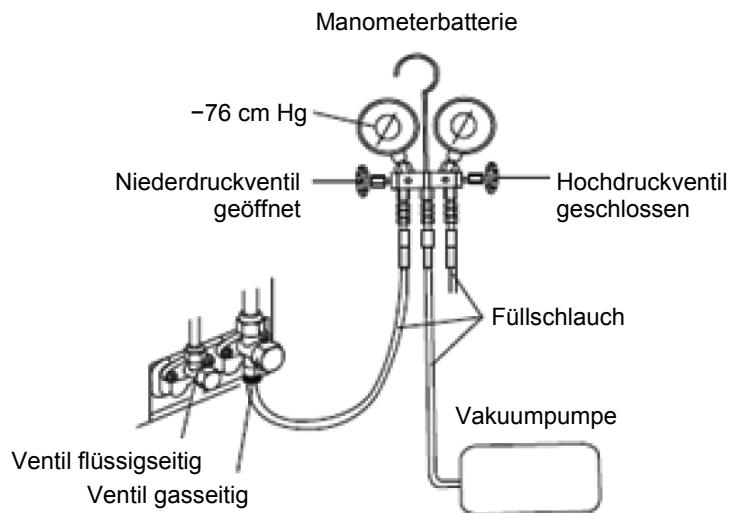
Anschlussplan für die Vakuumpumpe
